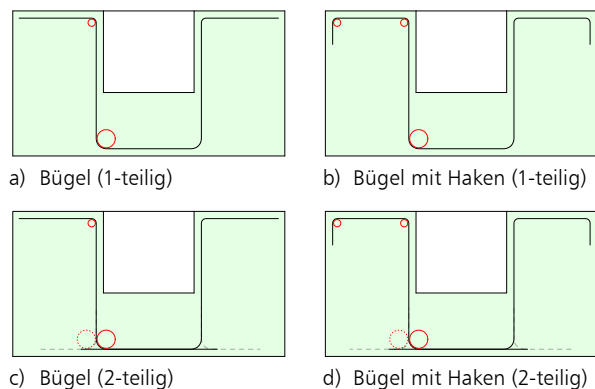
Bügelanordnung – vertikale Becherbewehrung
